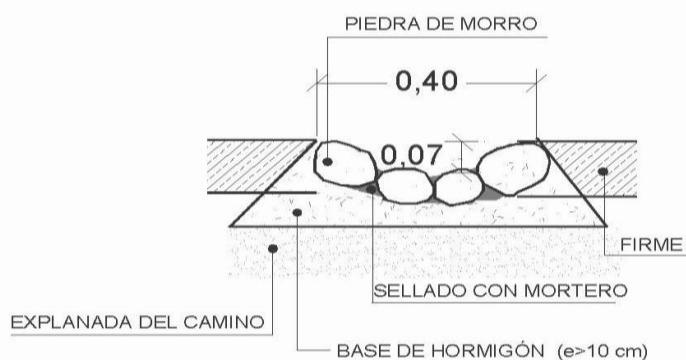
Sección y dimensiones de tajea de piedra. Se puede sustituir la piedra por adoquines de hormigón prefabricado.
